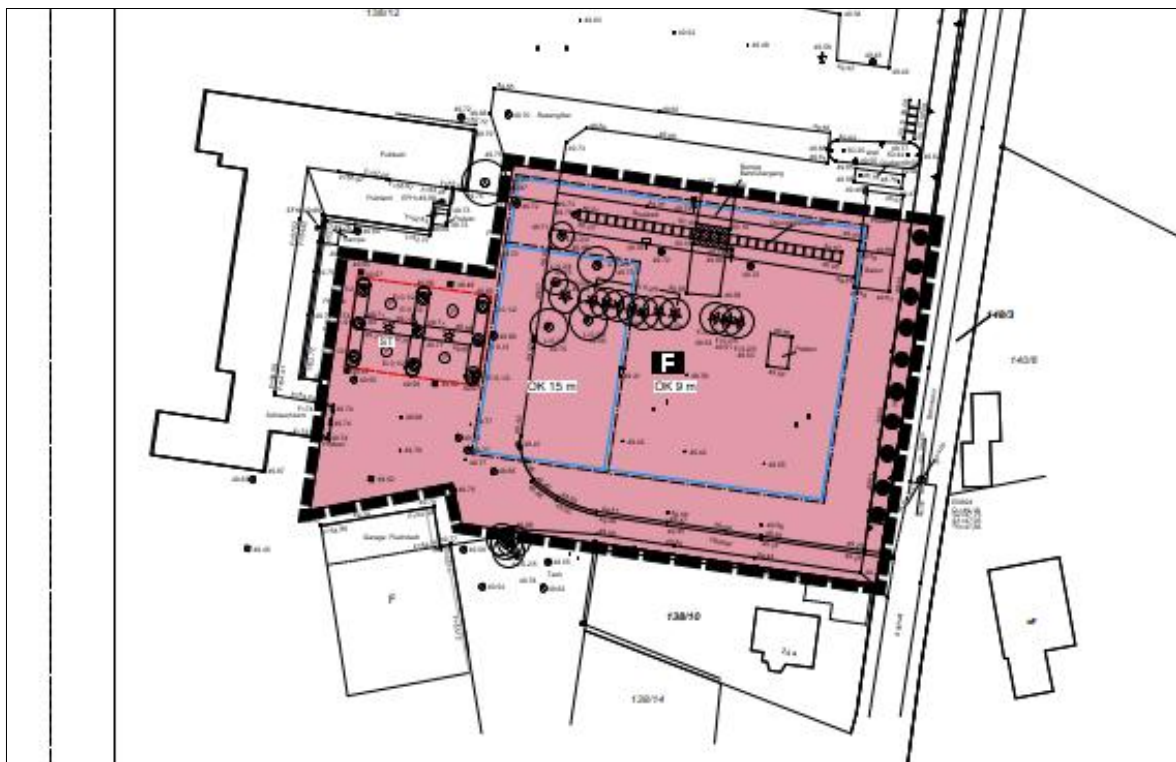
Ausschnitt 1. Änd. B-Plan Nr. 3, Gemeinde Elmenhorst
